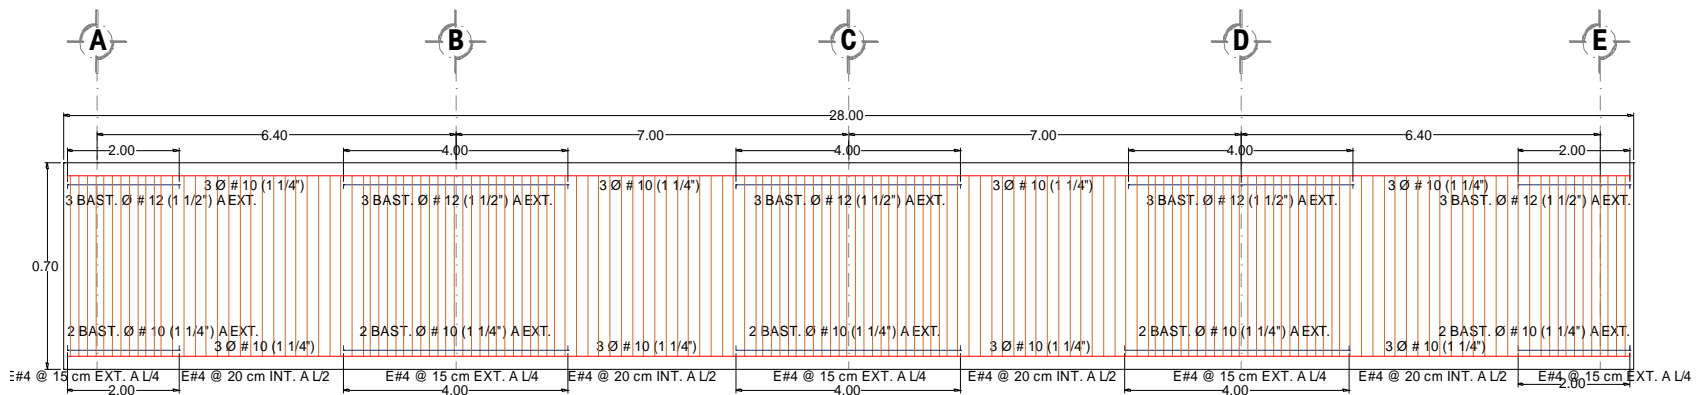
Detallado de armado de vigas y columnas del marco de 9 niveles con base a la hipótesis de las NTCC-17.
